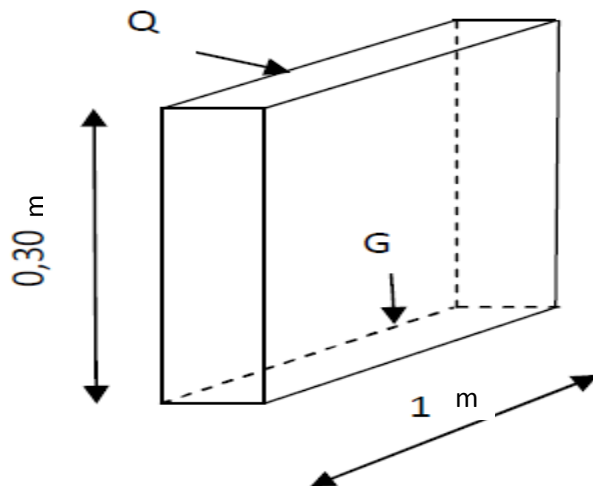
Coupe verticale de chéneau (dimensions en m)
